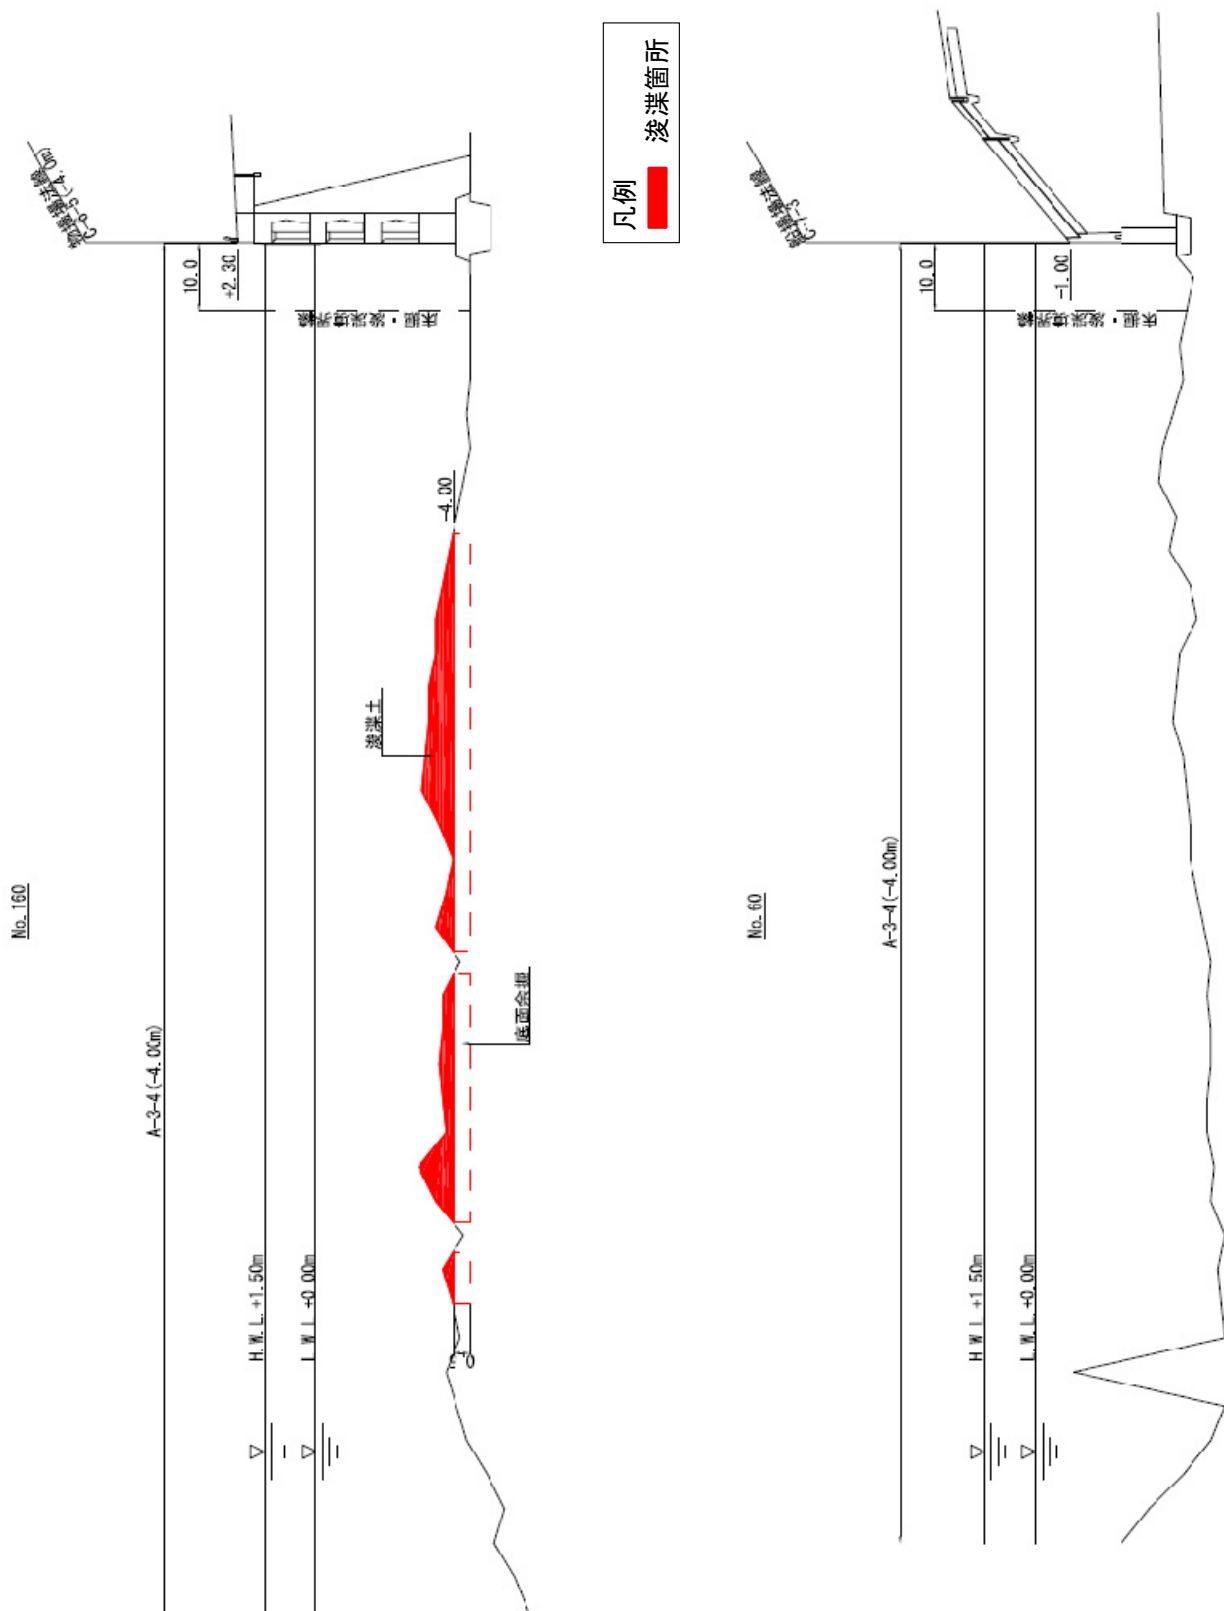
No. 1 半崎地区_1号泊地浚渫標準断面図(復旧後)
